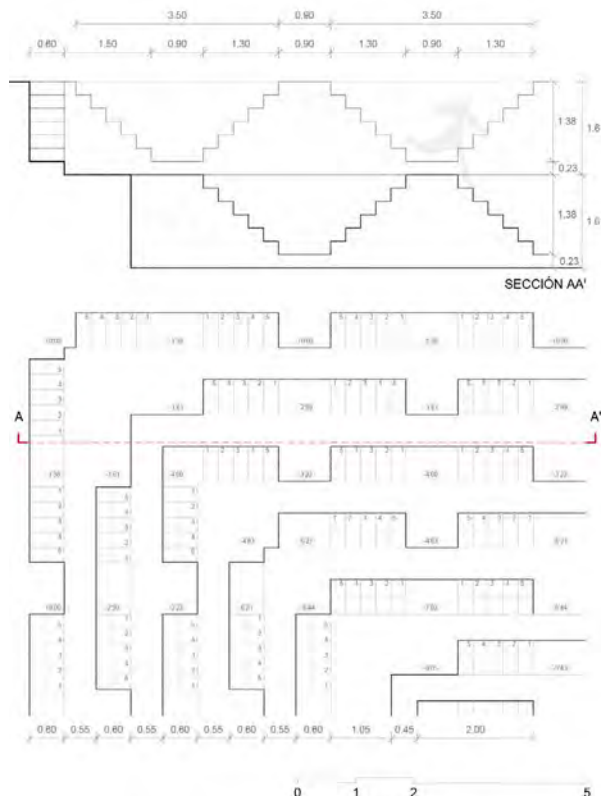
Detalle en planta y sección del escalonado de Chand Baori. Dibujado con medidas tomadas in situ.
